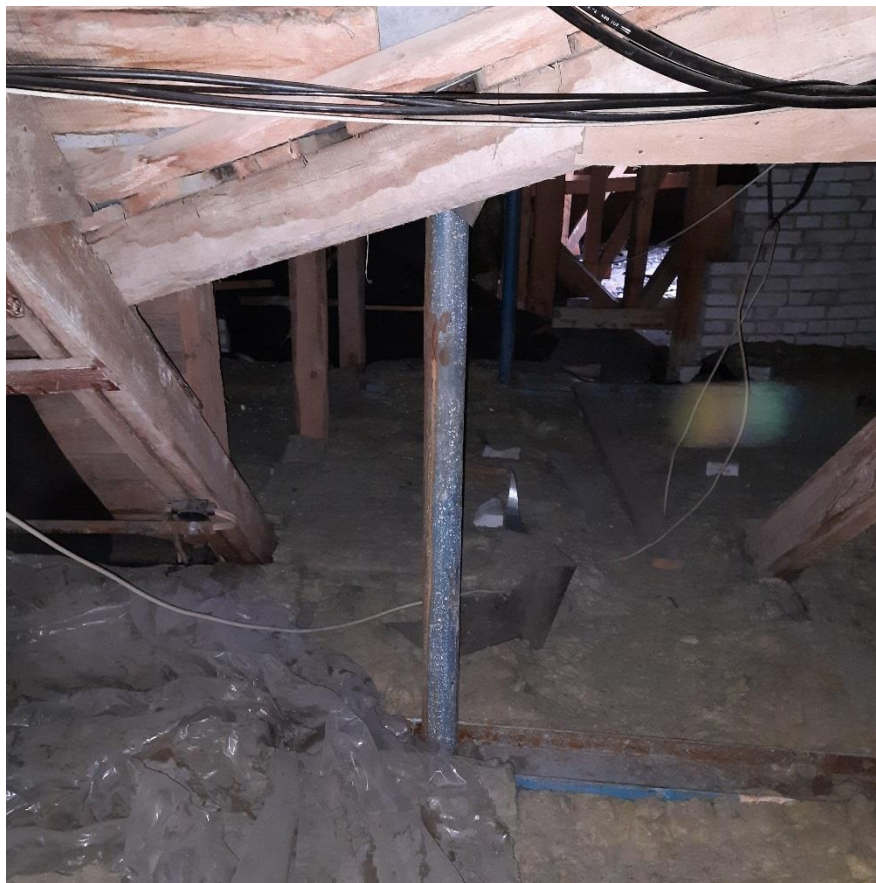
Чердак лицевого корпуса. Вид в сторону дворового корпуса.
